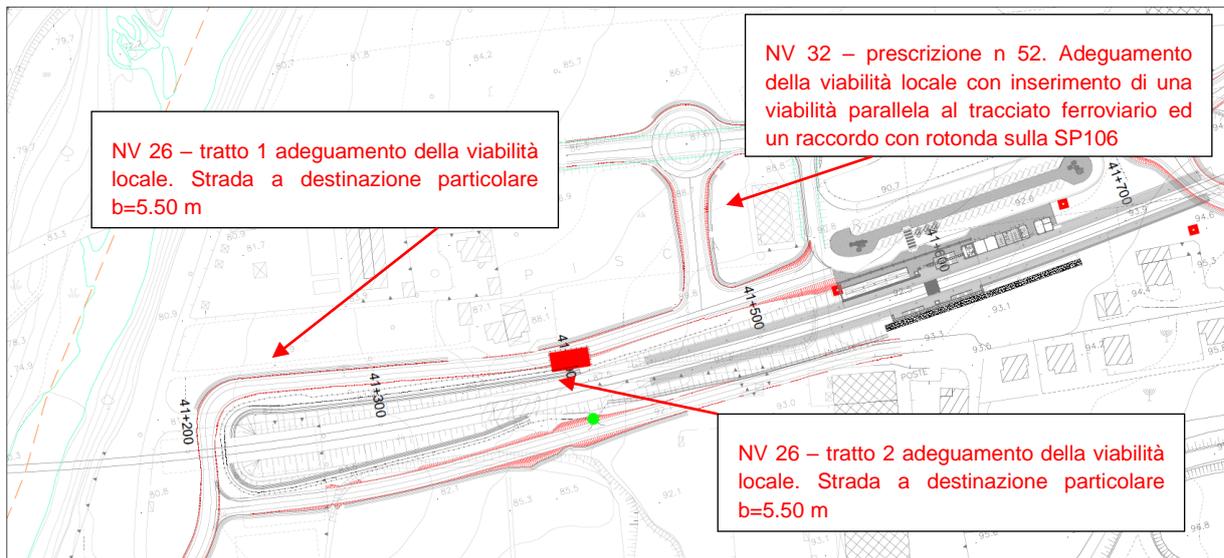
Contesto di analisi B - Stralcio planimetrico PE
